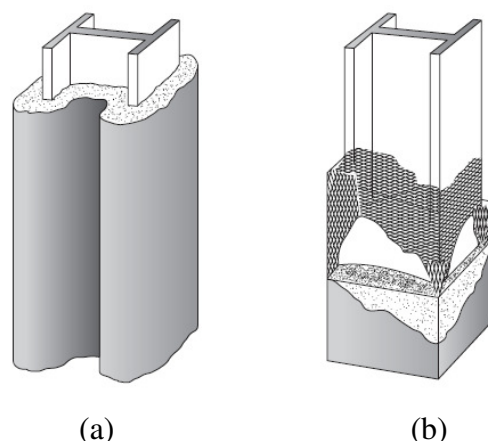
Material isolante pulverizado (a) e material isolante aplicado com o auxílio de uma tela metálica (b) (Milke, 2002).
